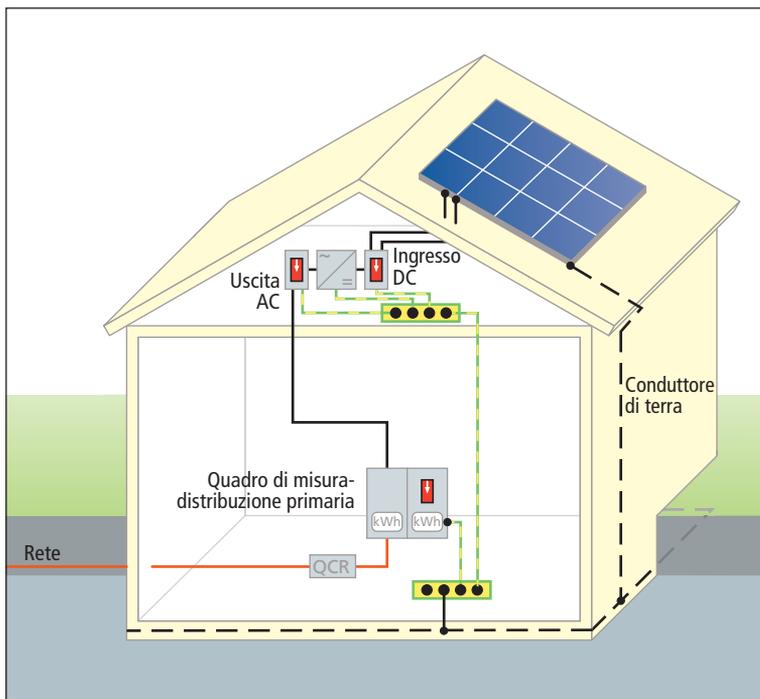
Concetto di protezione dalle sovratensioni per un impianto PV su un edificio senza protezione contro i fulmini esterna
